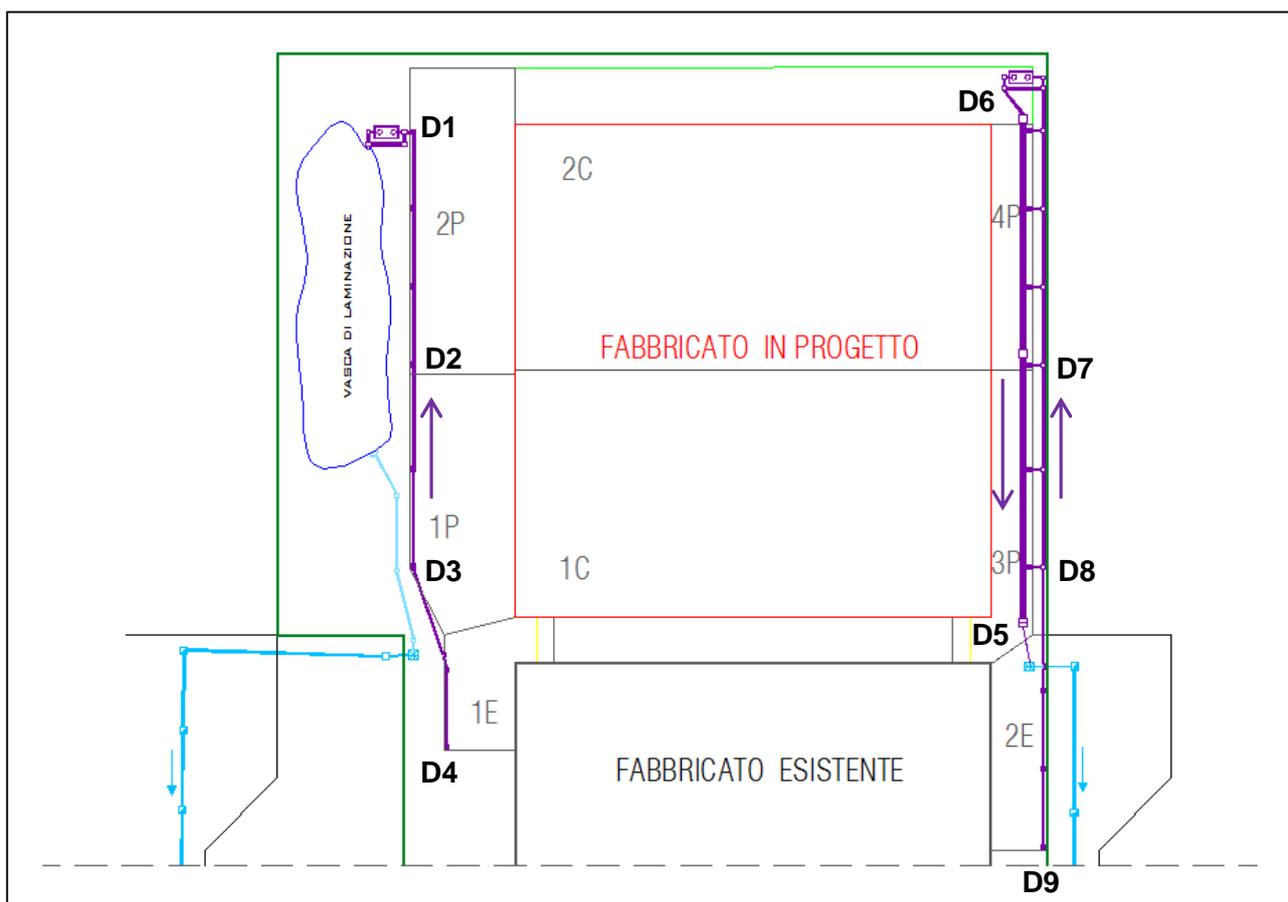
Planimetria rete meteorica di dilavamento (viola).
